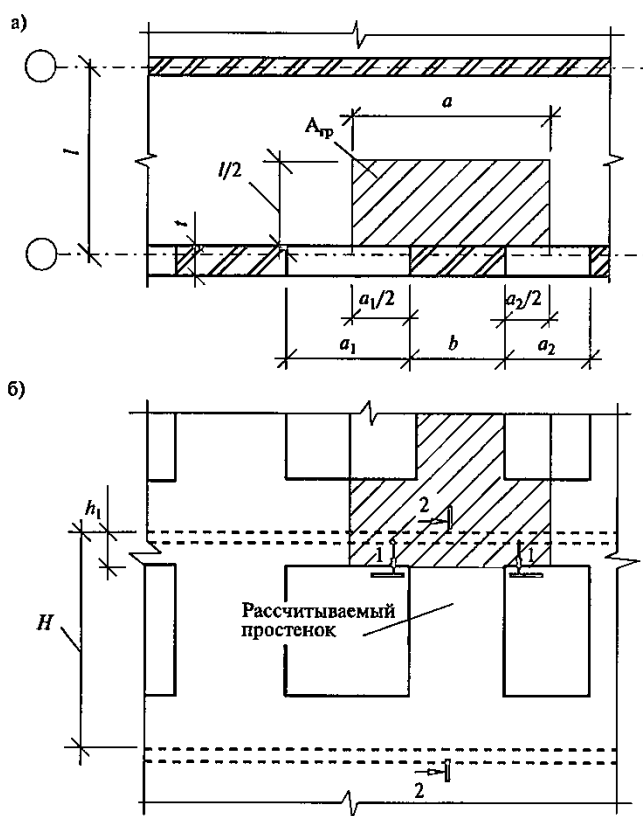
К расчету простенка: а) участок плана здания с грузовой площадью: a — ширина грузовой площади (расстояние между серединами оконных проемов); a_1 , a_2 — ширина оконных проемов; b — ширина простенка; l — толщина стены; б) участок фасада: H — высота этажа; h_1 — расстояние от плиты перекрытия до верха оконного проема
